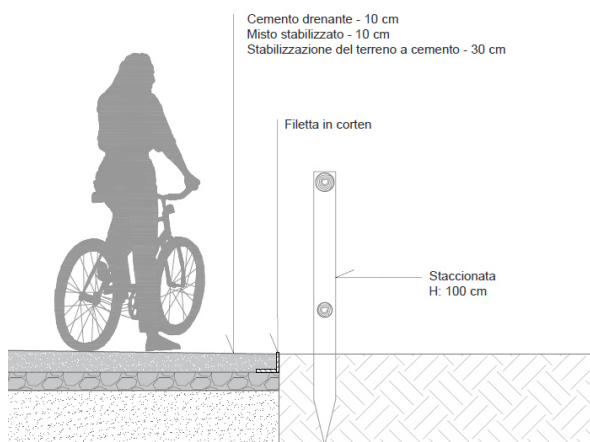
Pacchetto pavimentazione in calcestruzzo drenante
